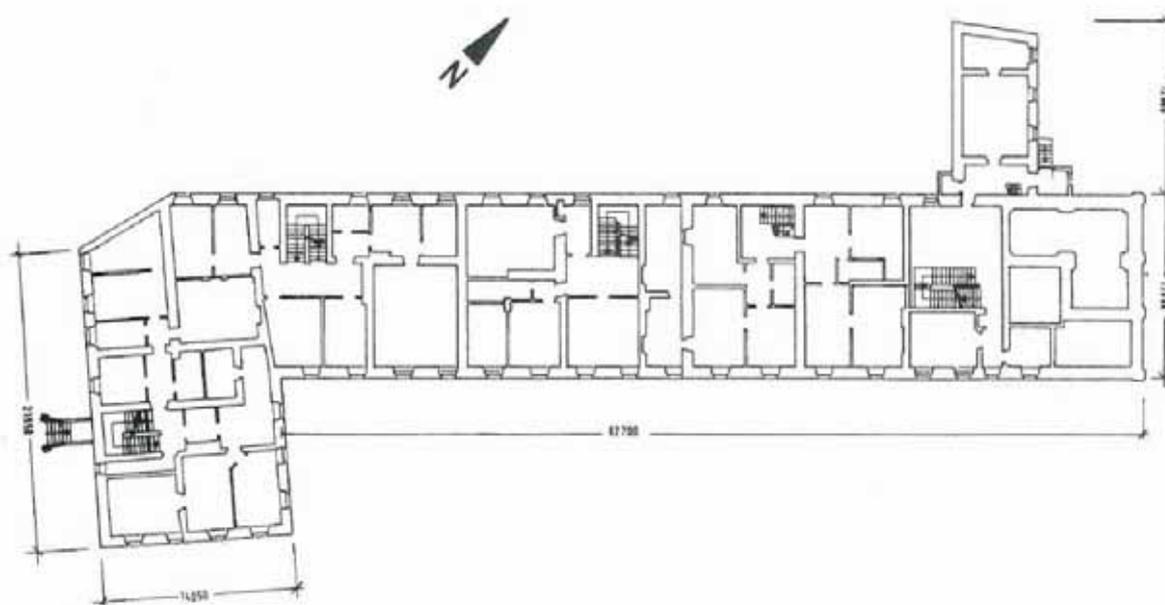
Grundriss des Beamtenhauses / Obergeschoss (Quelle: Klose & Klose 1997)
